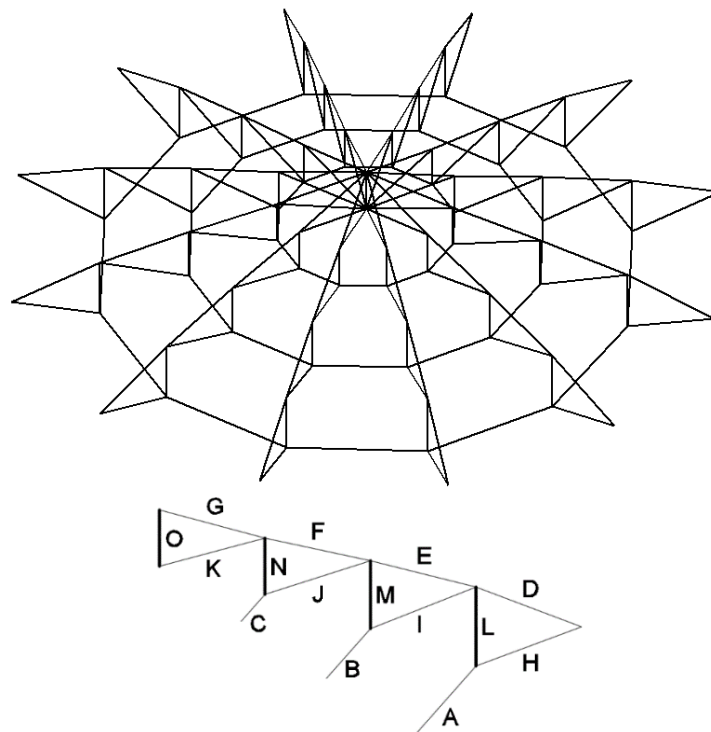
Estructura de cubierta propuesta con sus grupos de simetría (Ochoa & Orellana, 2016).
